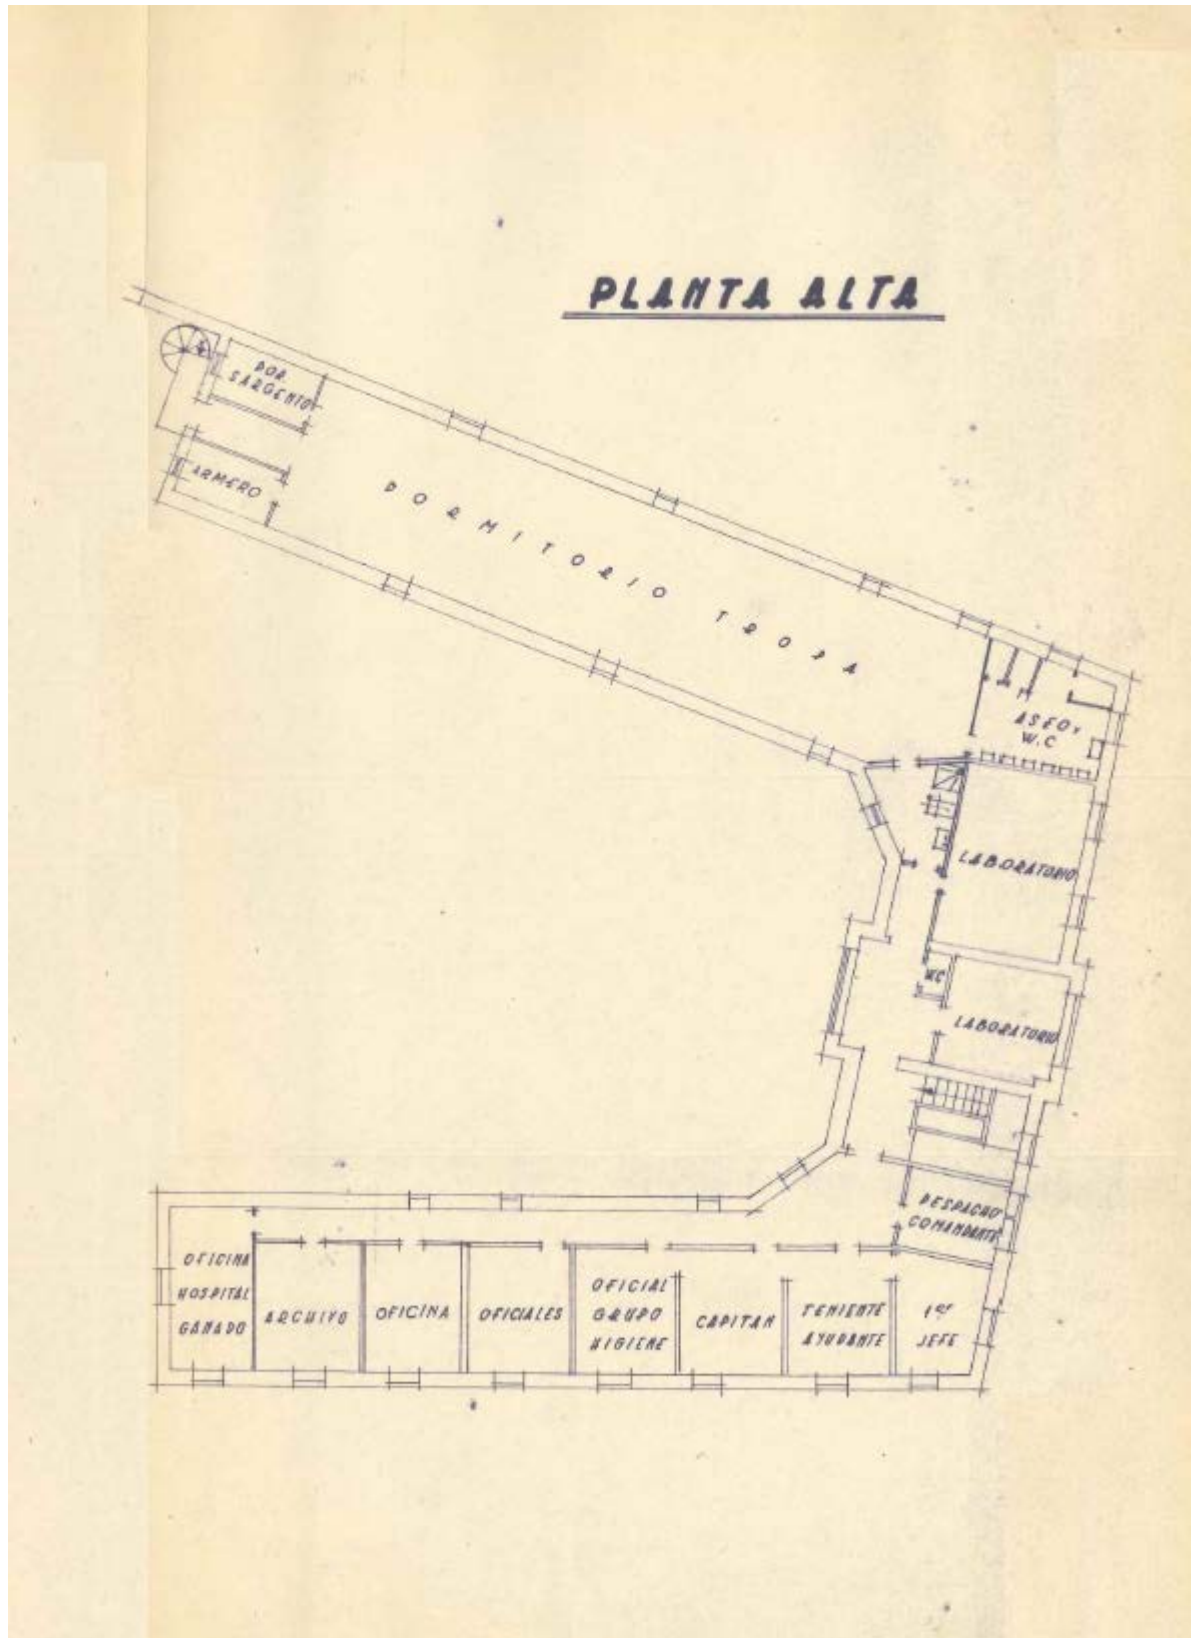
Plano de la primera planta del cuartel de Veterinaria (ca. 1960)
